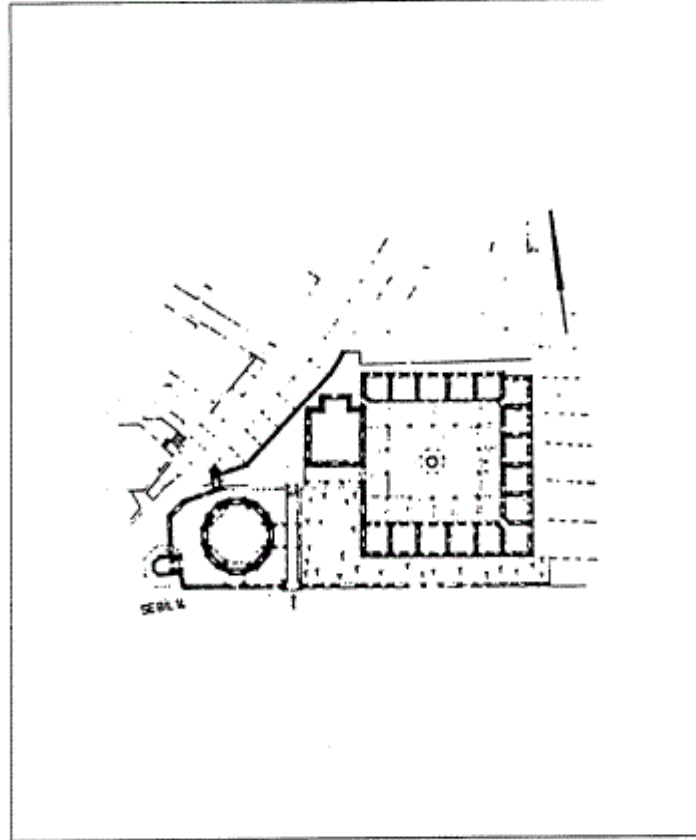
مسقط أفقي لمسجد الوالده الجديد (بنى جامع) في إستانبول (عن :
